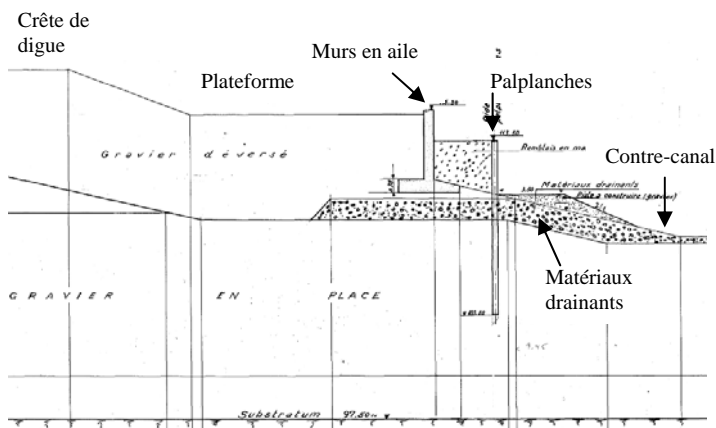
COUPE EN TRAVERS DE LA PLATEFORME
